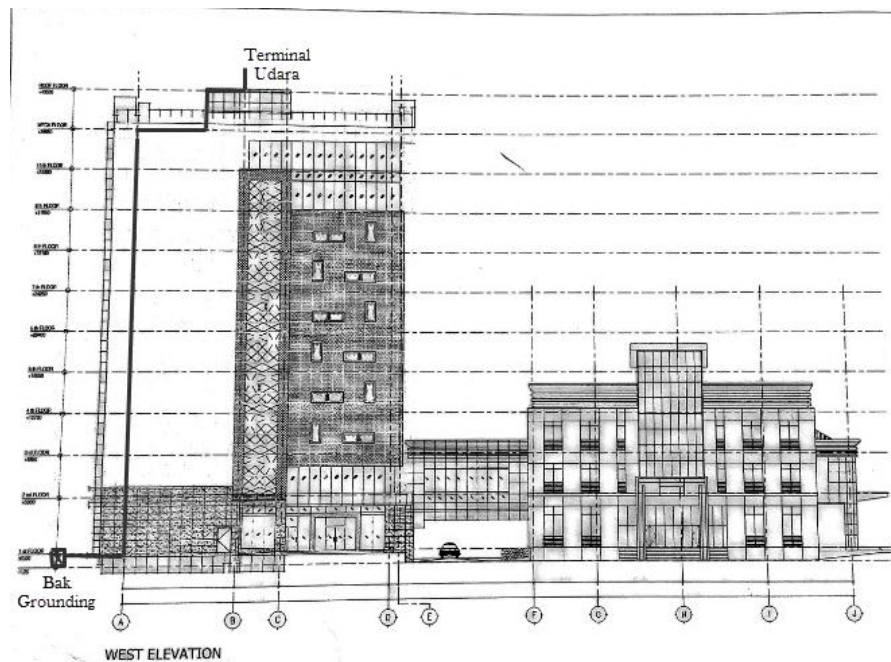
Detail Air Terminal Gedung Raden Adjeng Kartini
